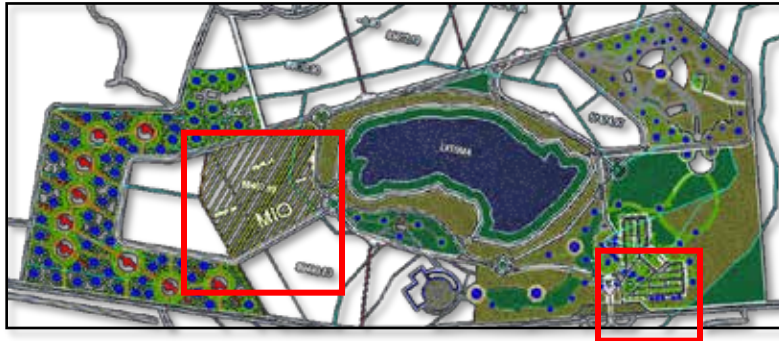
Plano ubicación de terreno en planta. Fuente: Urbanismo (2018)
